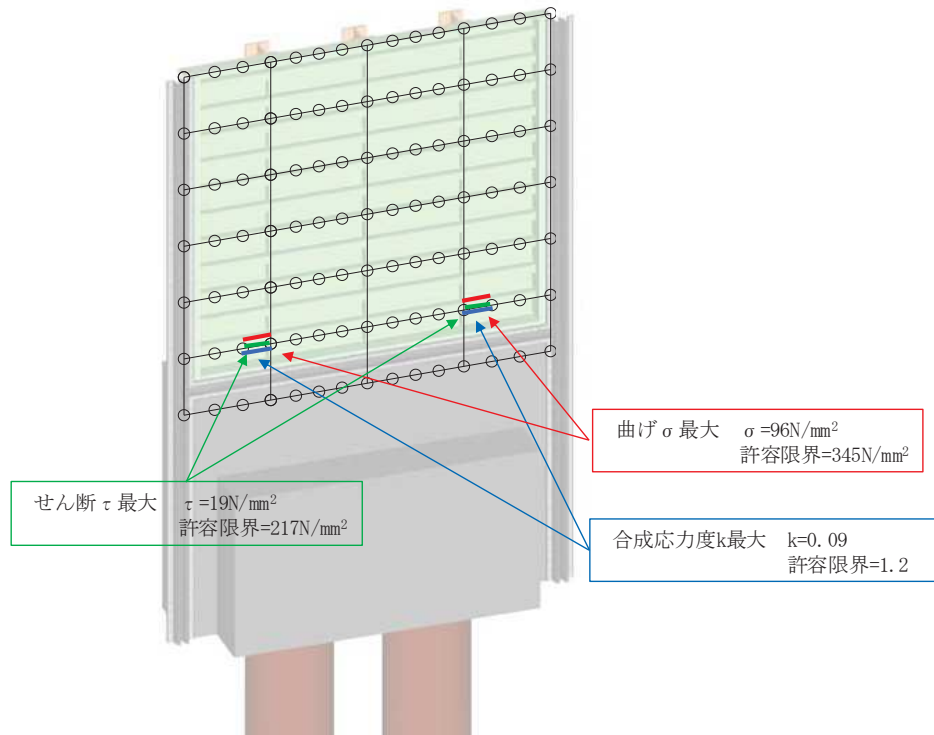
鋼板の曲げ・軸力系の破壊及びせん断破壊に対する
